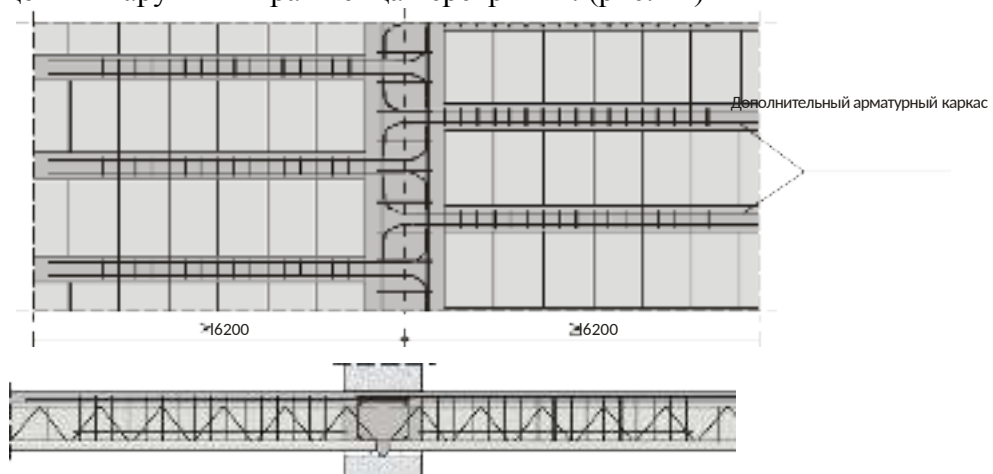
Дополнительный арматурный каркас, используемый в зоне опоры балок перекрытий «TERIVA - II» и «TERIVA - III» на стену.
